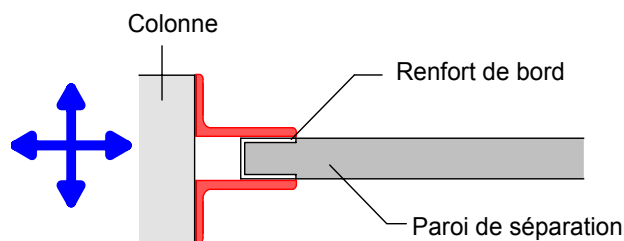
> Détails de construction de la fixation latérale d'une cloison
